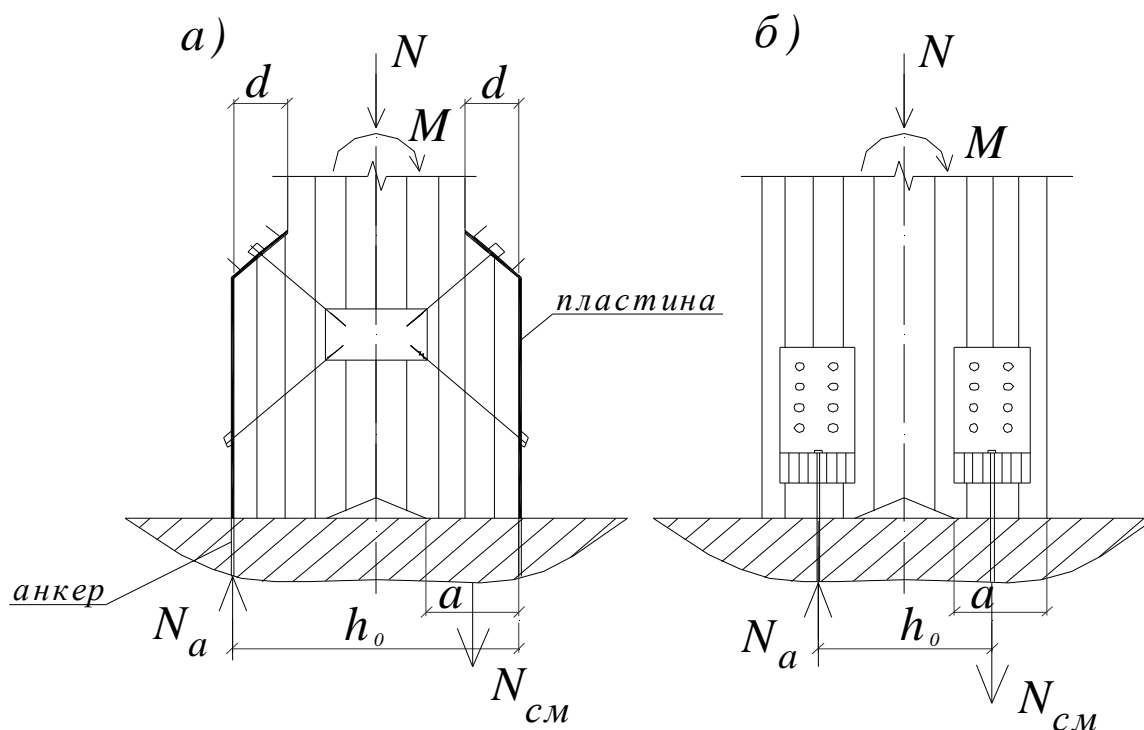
Жесткие узлы сопряжения стоек с фундаментами
